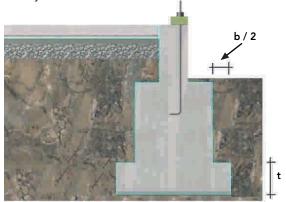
21: Ancho máximo de la zarpa sin armar.
